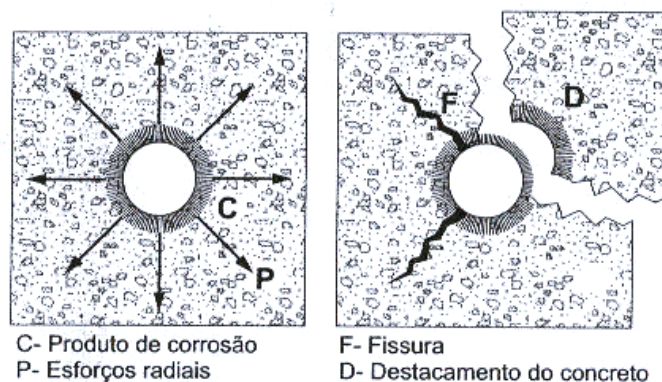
Esforços produzidos que levam à fissuração e destacamento do concreto (CASCUDO, 1997).
